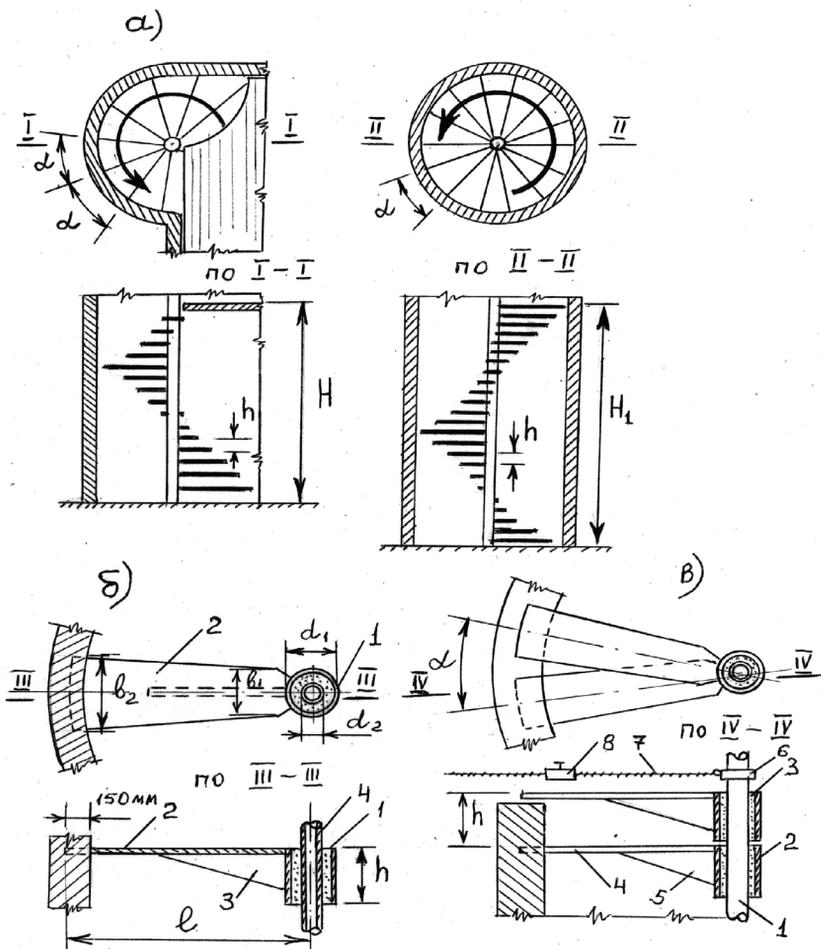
Технология устройства винтовых лестниц: а) параметры винтовых лестниц; б) конструкции винтовых лестниц; в) технология установки маршей винтовых лестниц; 1 – труба – стойка; 2 – втулка из трубы; 3 – косынка;
